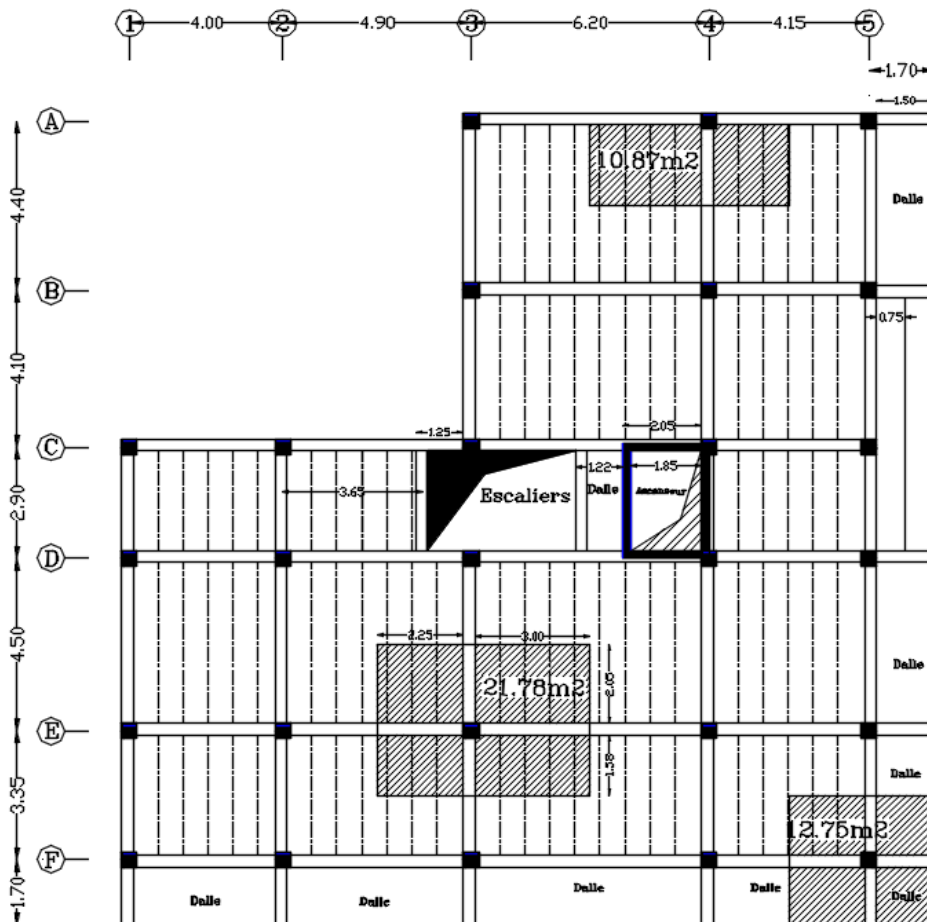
Surfaces de plancher repris par les poteaux types.
